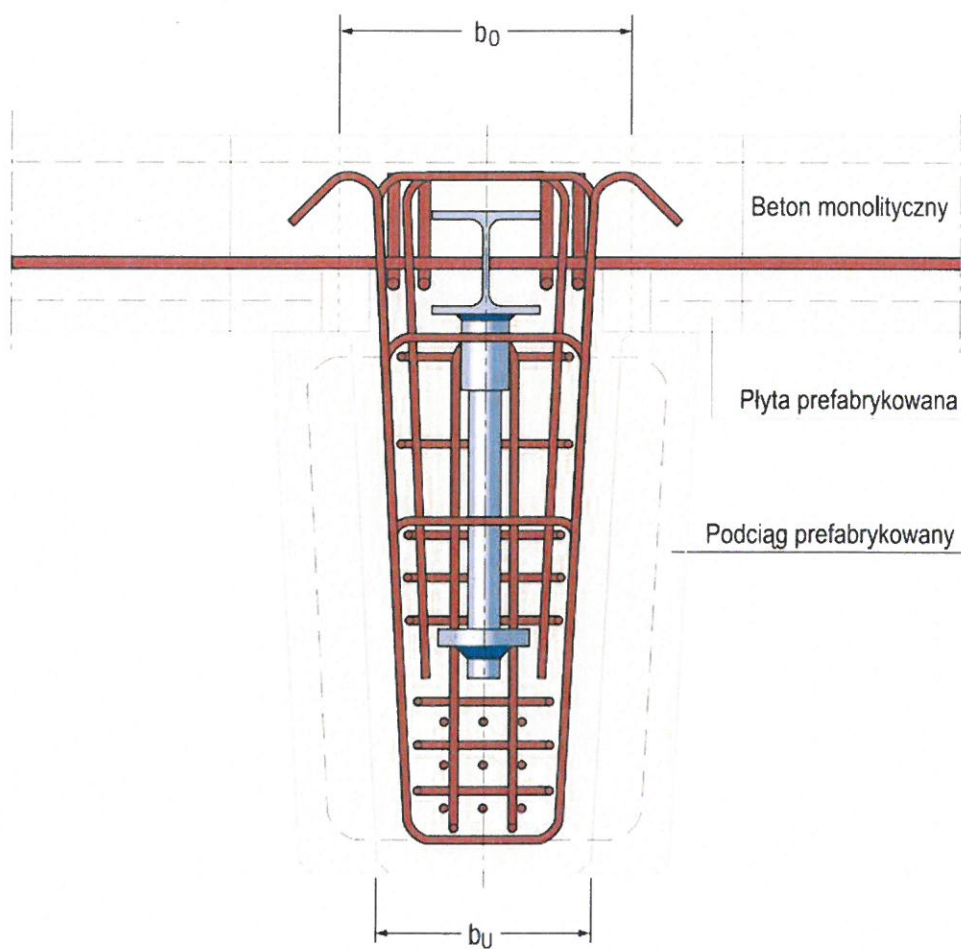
Podparcie prefabrykowanego elementu żelbetowego,
